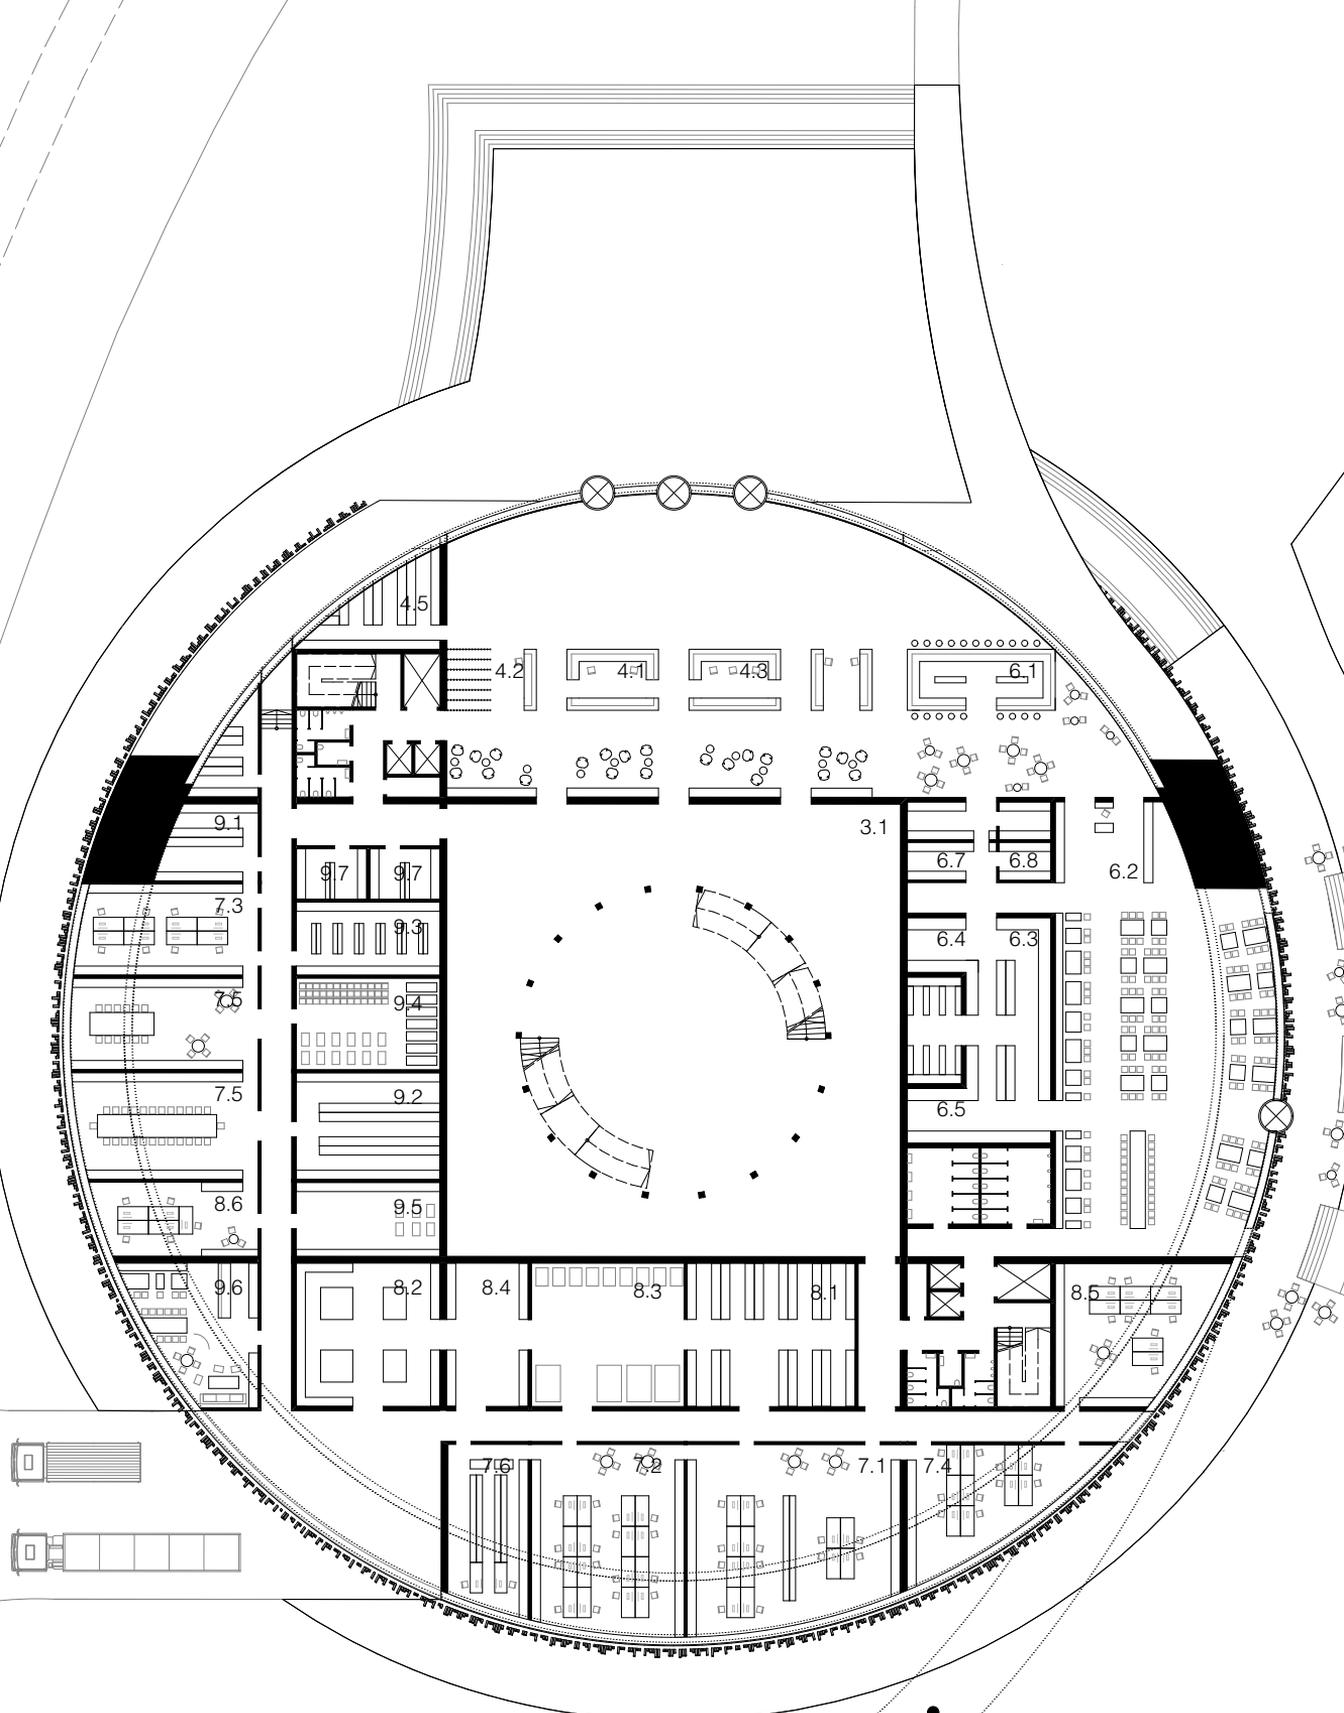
Grundriss Erdgeschoss - Eingang & Verwaltung - M1:500
